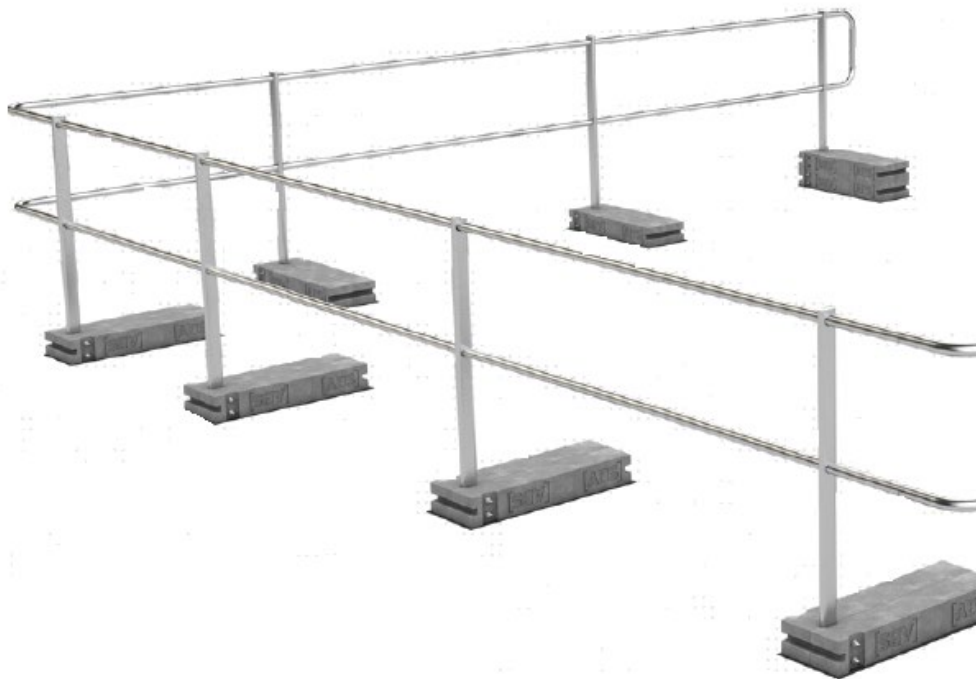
ABS Guard onTop Weight (Montagebeispiel mit Betongewichten)
